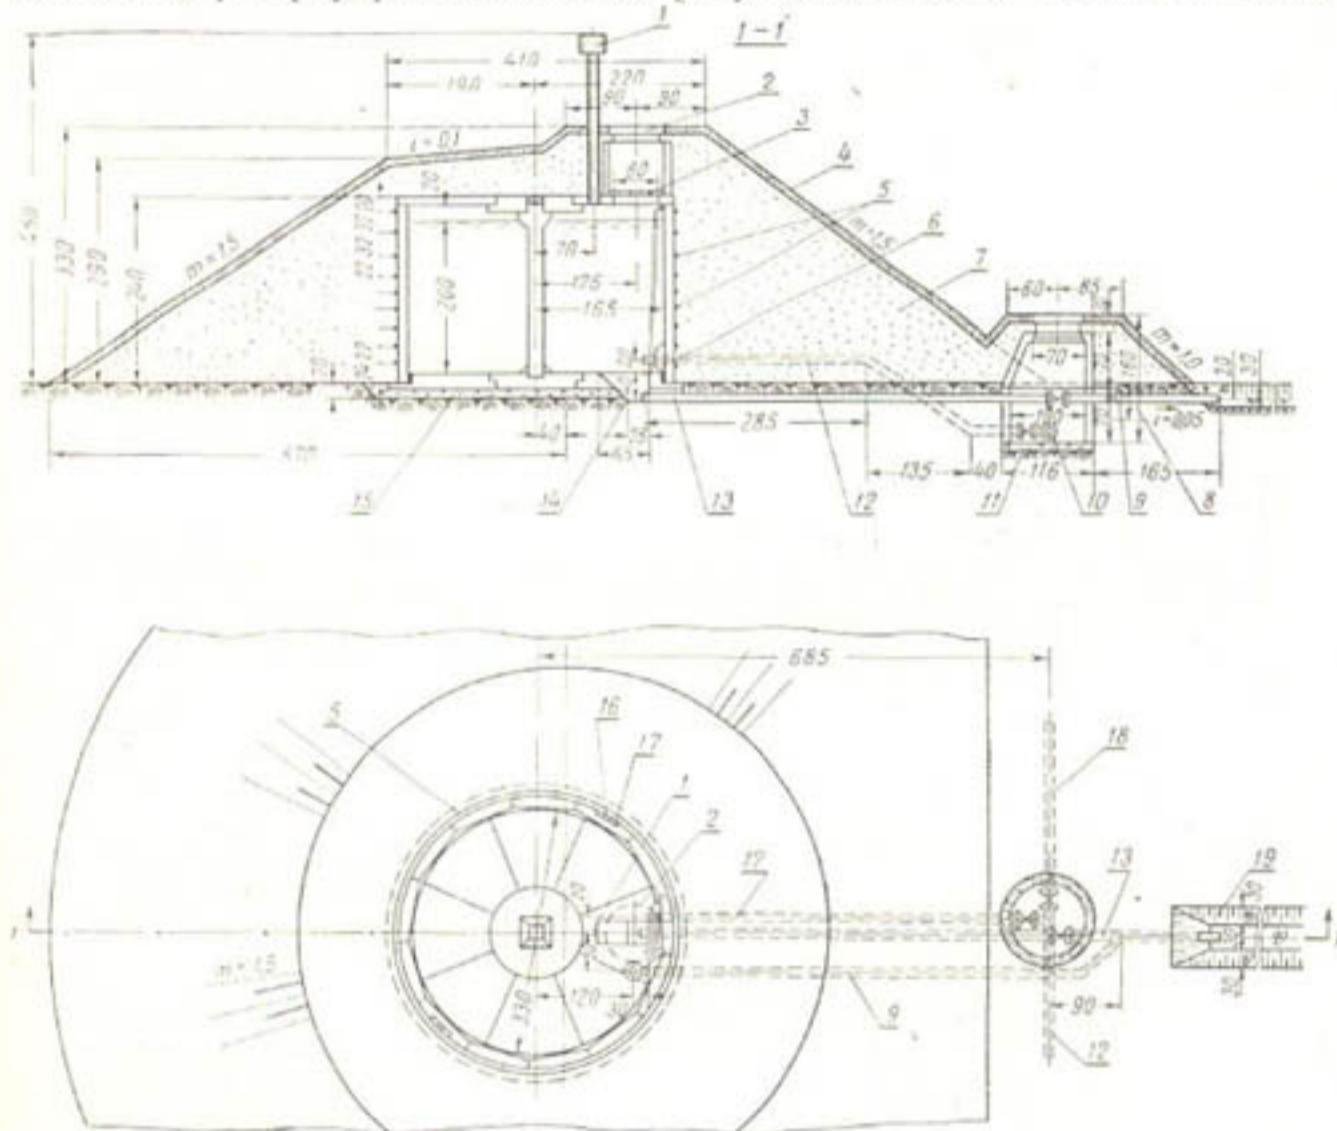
Круглый резервуар из сборного железобетона емкостью 15  $m^3$ :
